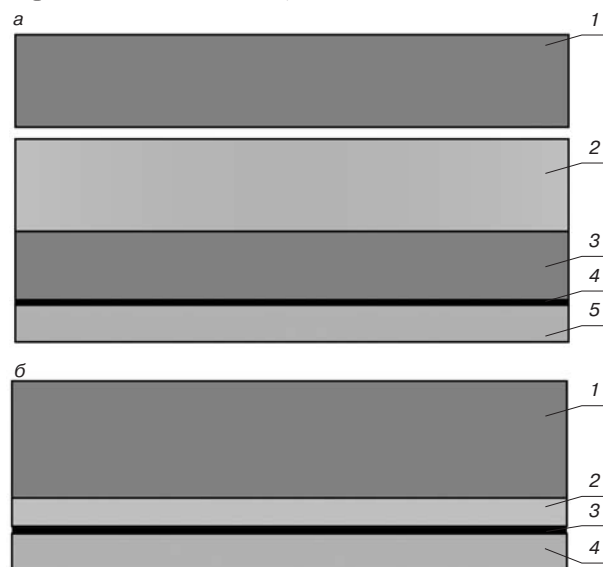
Конструкции дорожной одежды мостового полотна, рекомендуемые к применению на металлической ортотропной плите Б: с покрытием из литой сероасфальтобетонной смеси: а – проезжая часть: 1 – литой сероасфальтобетон I типа, слоем 40 мм; 2 – асфальтобетон типа А, Б или литой сероасфальтобетон I типа, слоем 40 мм; 3 – мастика битумно-полимерная наполненная, расход 55 кг/м², слоем 20 мм; 4 – битумно-полимерная эмульсия, расход 0,7–0,8 кг/м²; 5 – металлическая ортотропная плита; б – тротуар: 1 – литой сероасфальтобетон II типа, толщиной 30 мм; 2 – мастика битумно-полимерная наполненная, расход 27 кг/м², слоем 10 мм; 3 – битумно-полимерная эмульсия, расход 0,7–0,8 кг/м²; 4 – металлическая ортотропная плита
